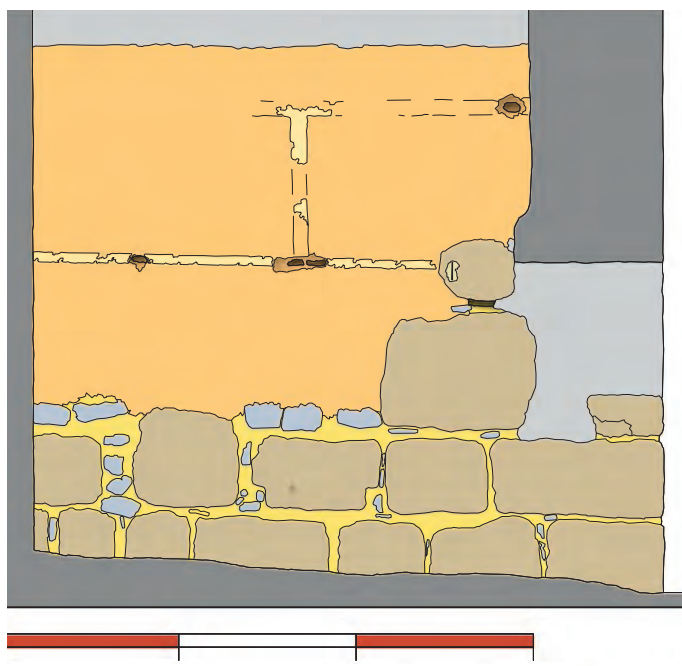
Alzado meridional de la base de la torre albarrana. Se aprecia la leve inclinación de la cinta horizontal inferior.
